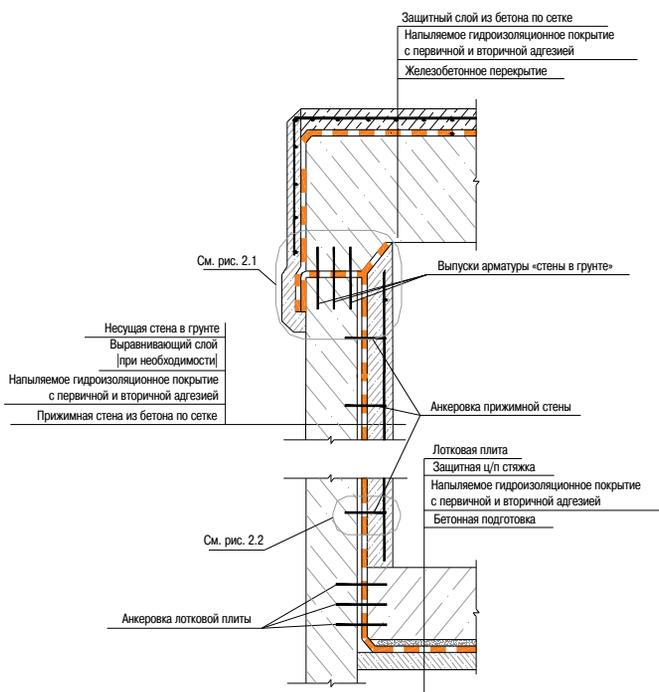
Схема устройства гидроизоляционной системы при открытом способе работ с использованием стены в грунте в качестве несущей
